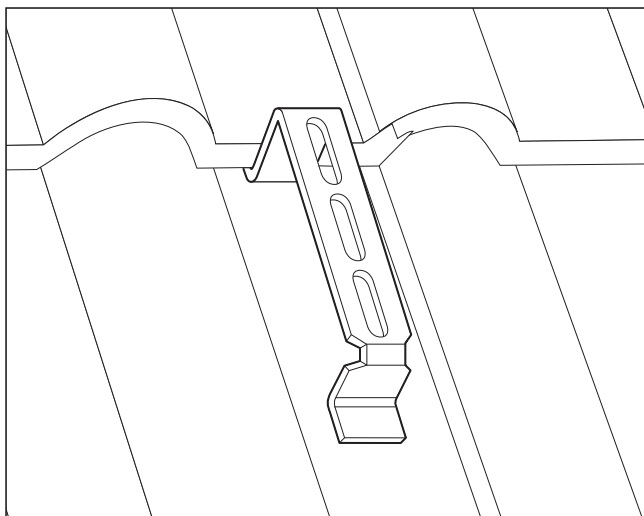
Prostokątne dachówki esówki, jak np. dachówka frankfurcka
